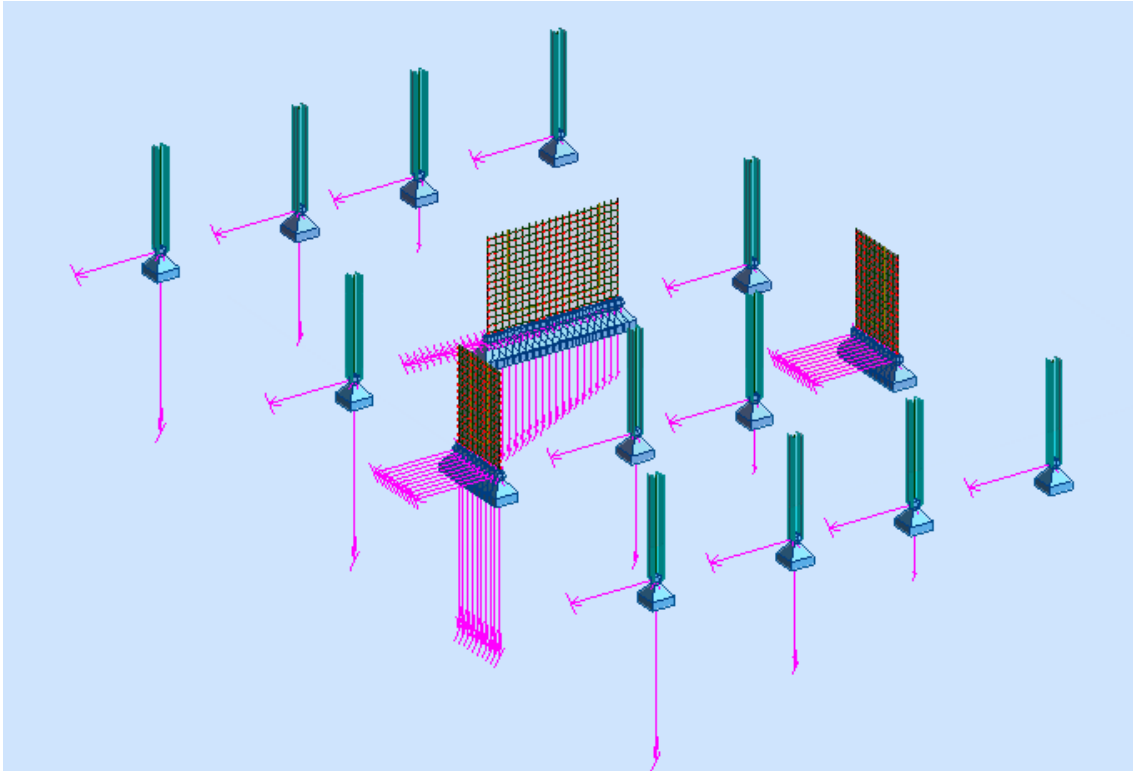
ad Esquema desplazamiento muro paralelo
